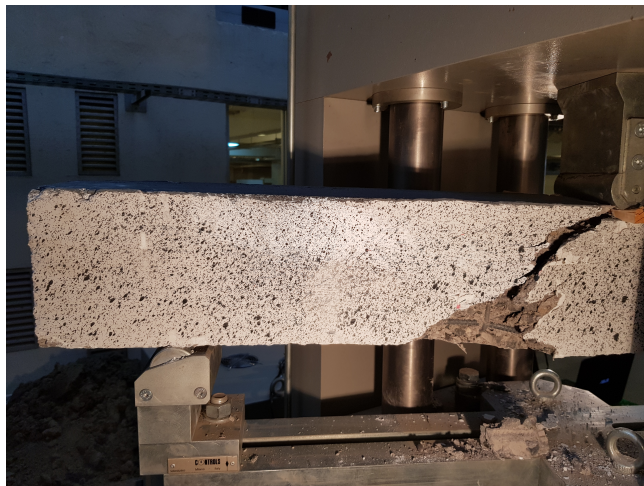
Viga 1 - Perfil de la viga una vez que el elemento ha fallado.
